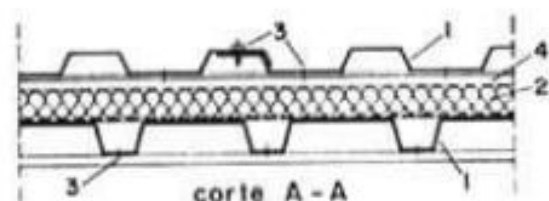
TIPOS E DETALHES DE COBERTURA COM TELHAS TRAPEZOIDAIS
